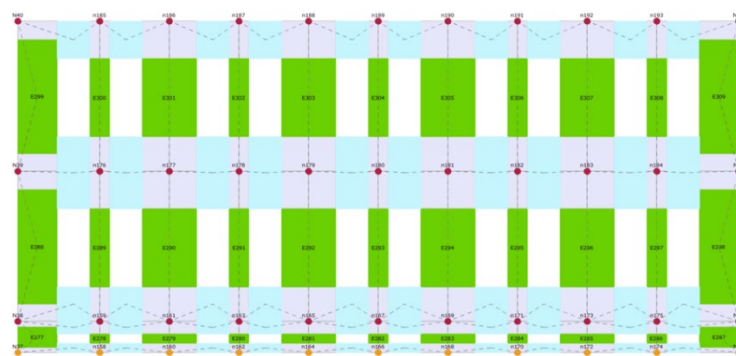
Sollecitazioni Parete P8 | Prospetto Nord-Ovest
